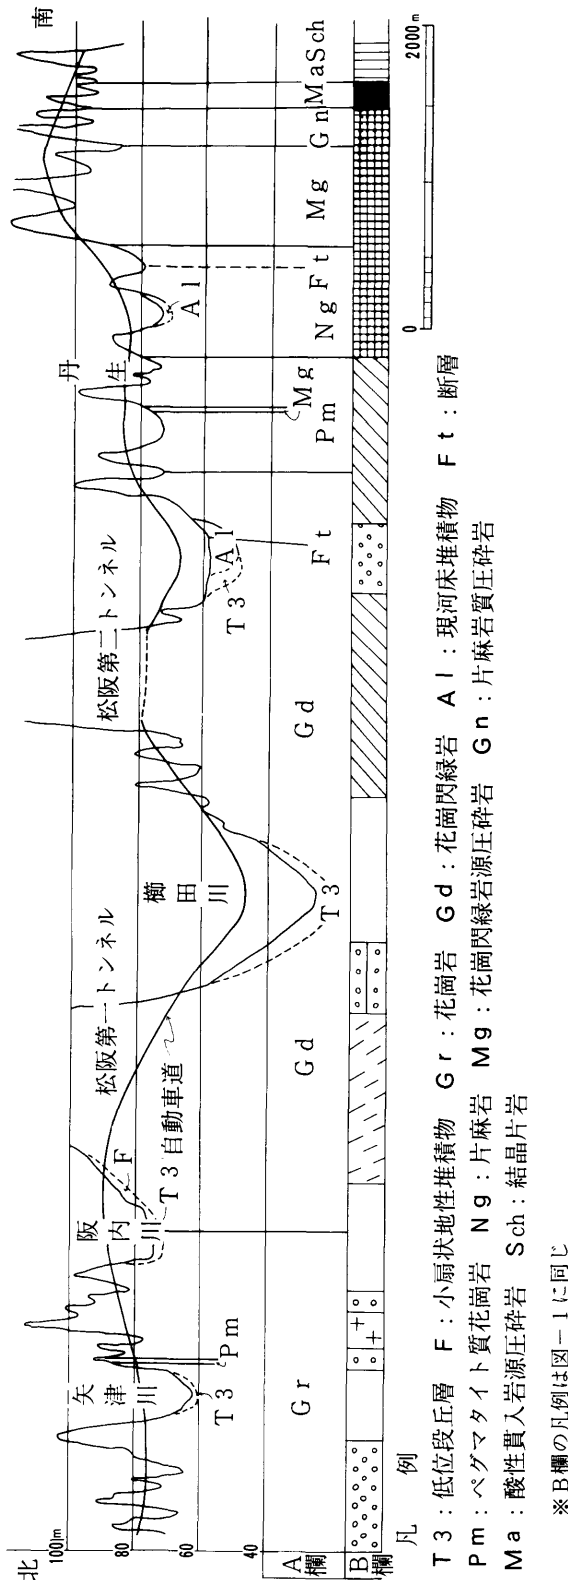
地質断面図 (A棟: 道路公団 B欄: 筆者)
